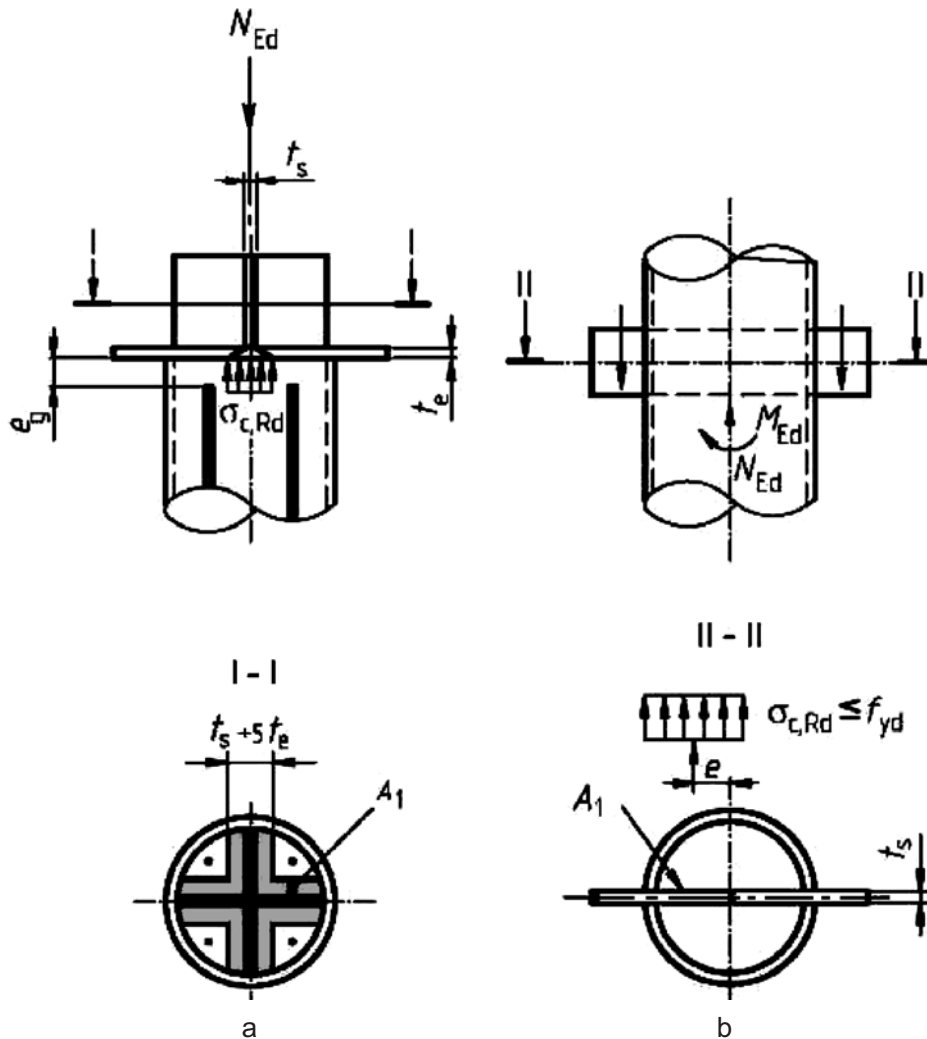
Частково навантажені та заповнені бетоном круглі порожністі перерізи
